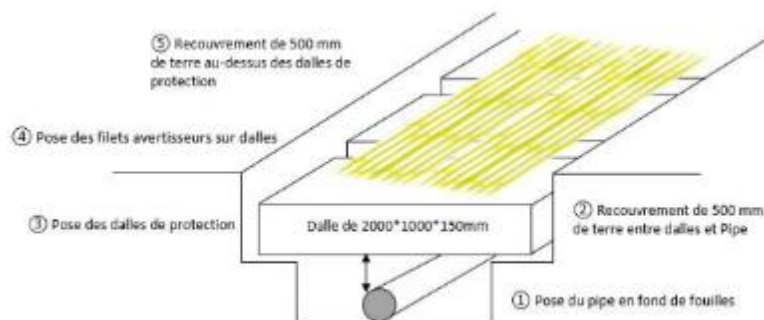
Schéma typique d'un crossing de route rencontrée lors de la pose.
